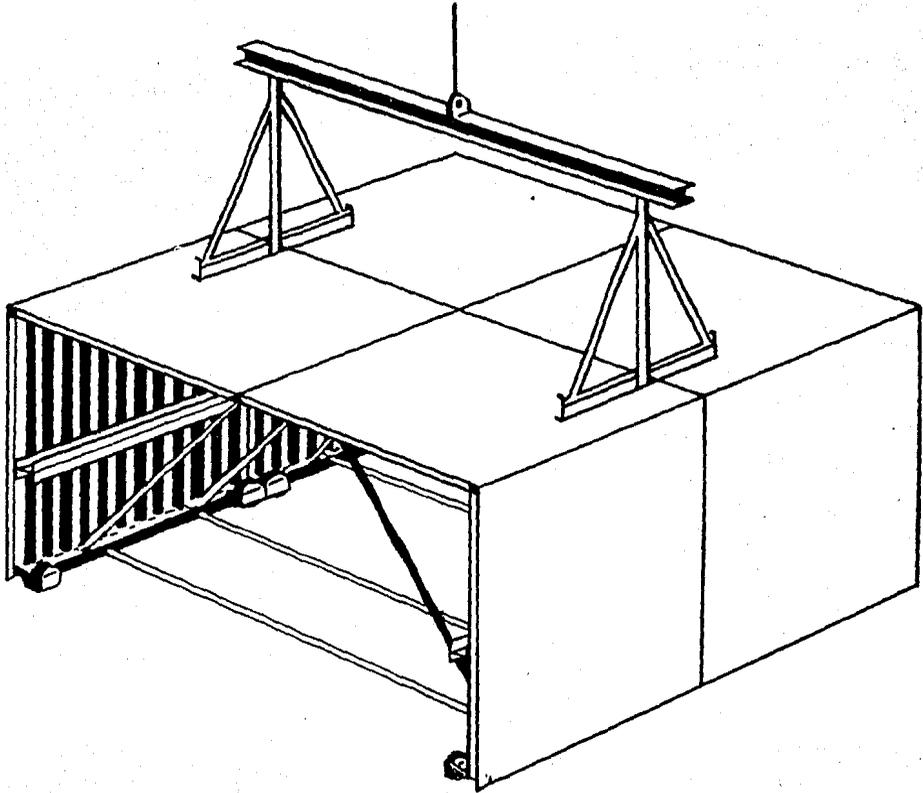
Túnel completo elevado por medio de tripies de levantamiento y balance.
